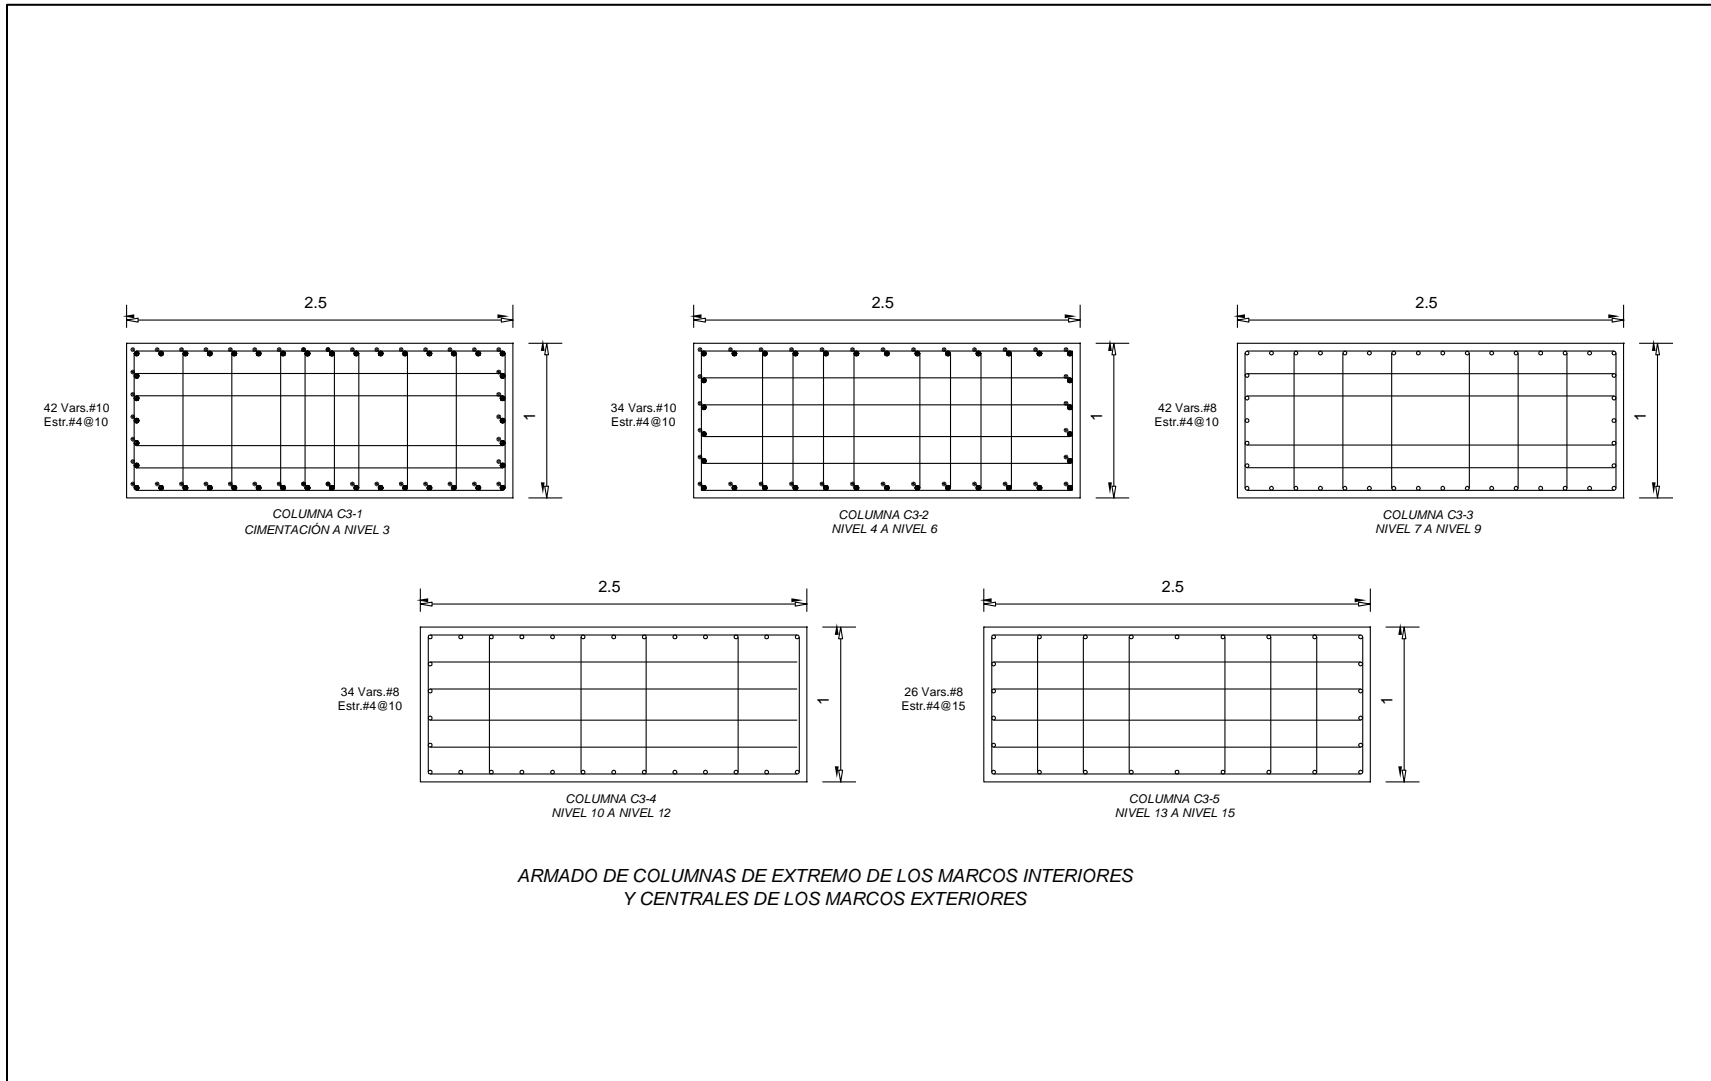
Detalles estructurales del edificio de 15 niveles diseñado con el ACI318-08
